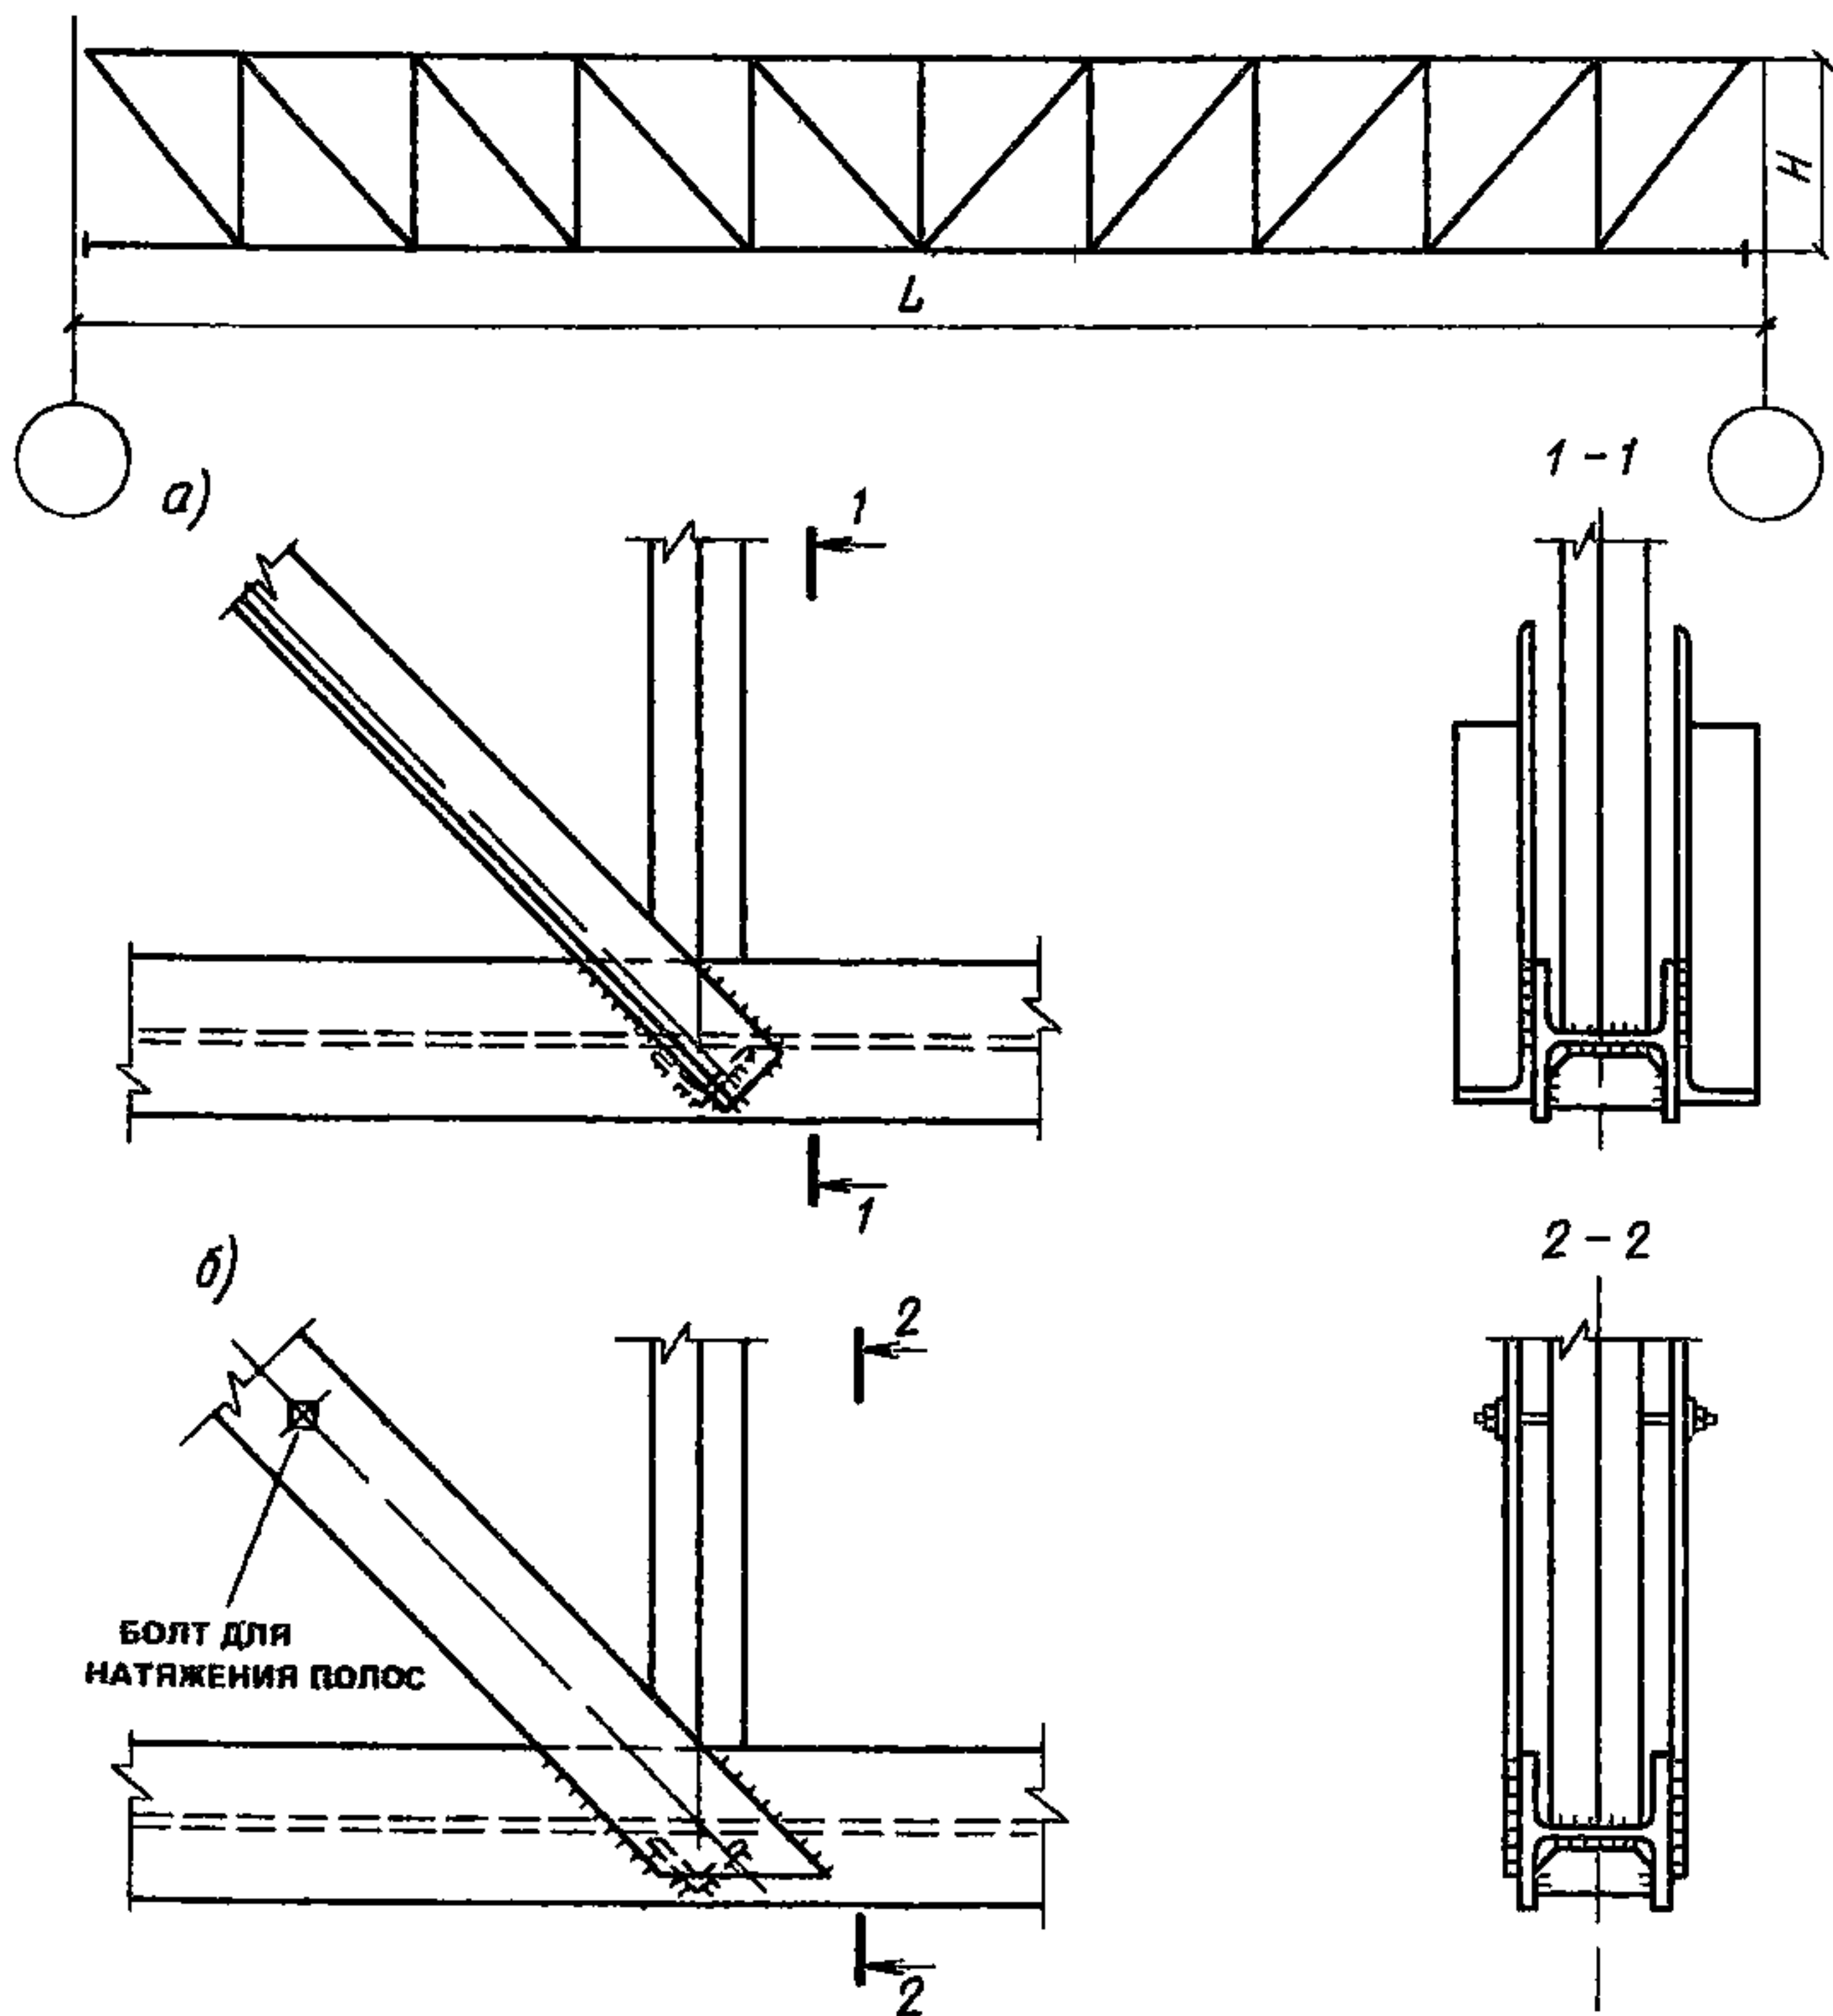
Узел фермы с поясами из горизонтально расположенных двутавров с бесфасоночным примыканием элементов решетки с раскосами
